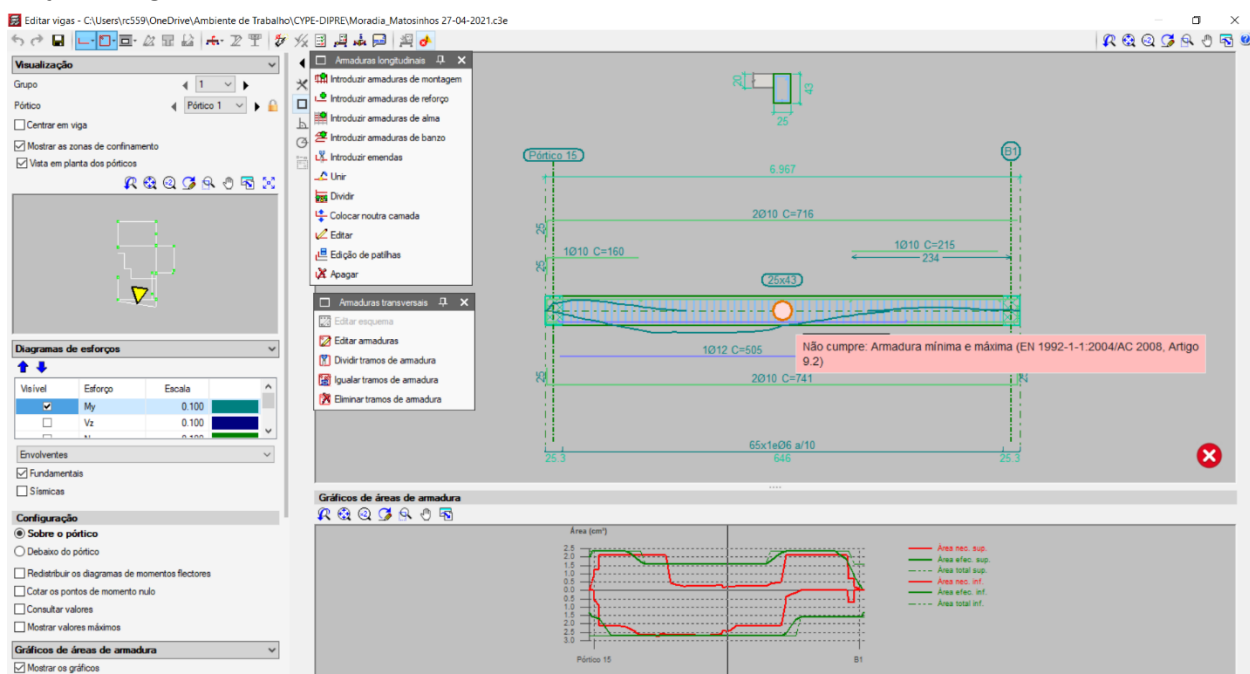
Erros na viga V1 (Fonte: CYPE)
